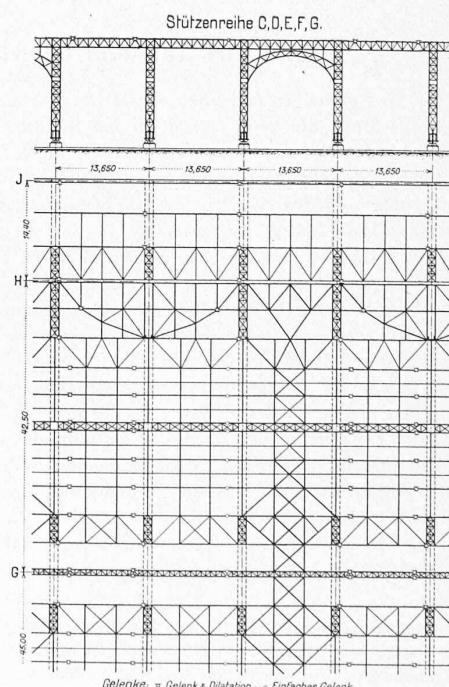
Draufsicht auf Halle VI und Randhalle.
